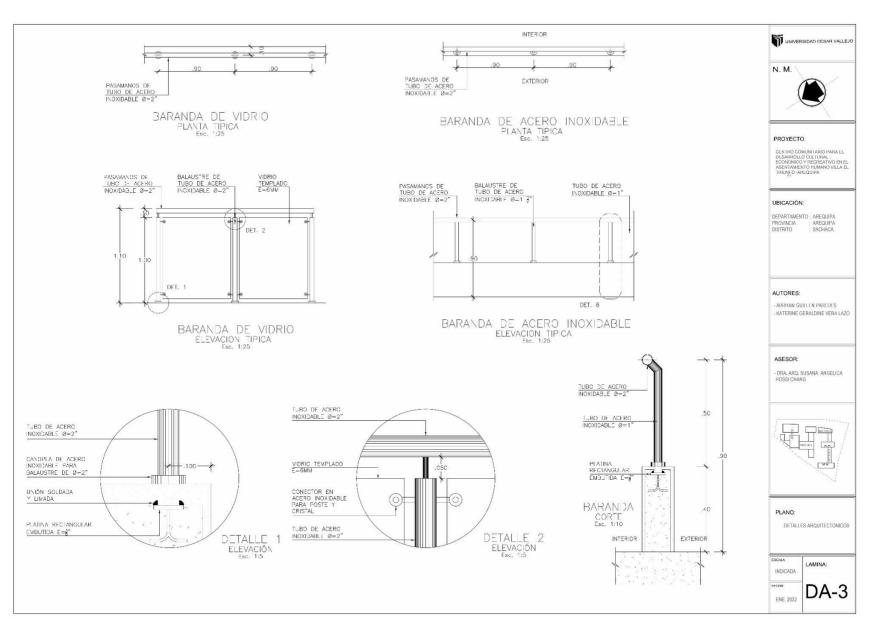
Plano de Detalles Arquitectónicos (Barandas Exteriores) - Elaboración propia
